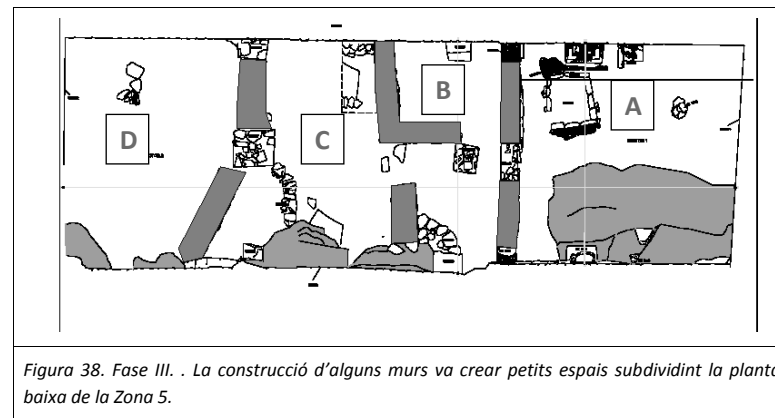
Fase III. . La construcció d'alguns murs va crear petits espais subdividint la planta baixa de la Zona 5.
